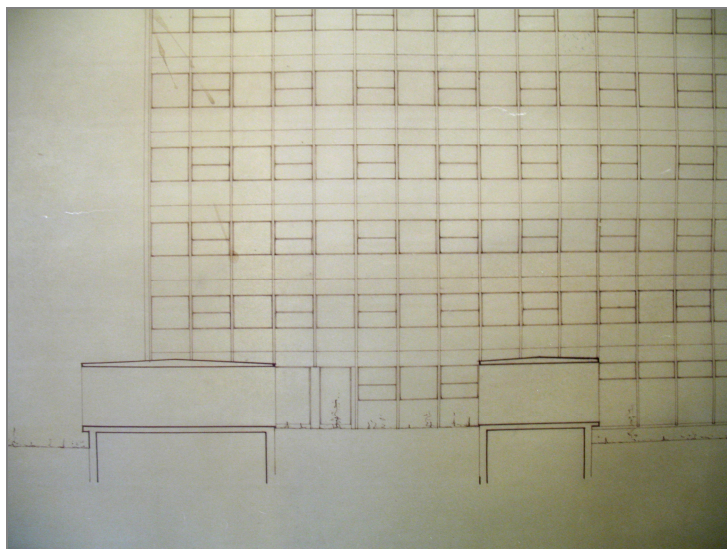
particolare prospetto verso l'autostrada (fonte CSAC – stralcio tav. 68, archivio n. 181-2)
